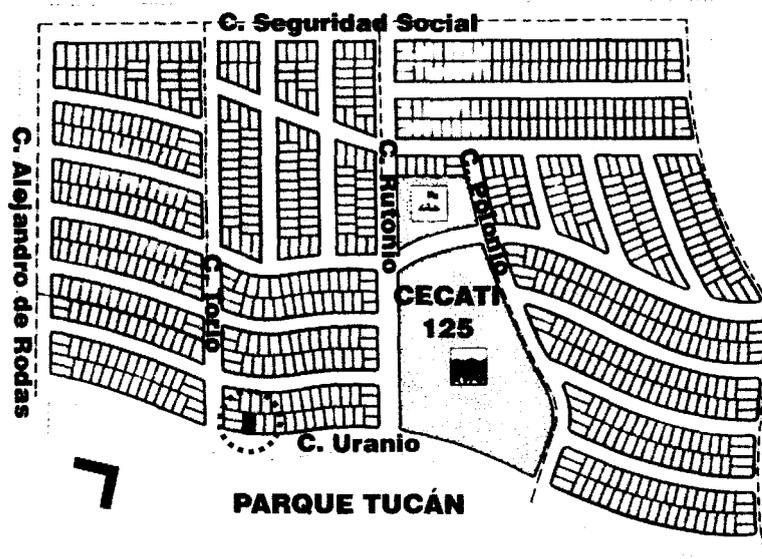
Planta general del conjunto Valle INFONAVIT V. Fuente: INFONAVIT, 1988.
